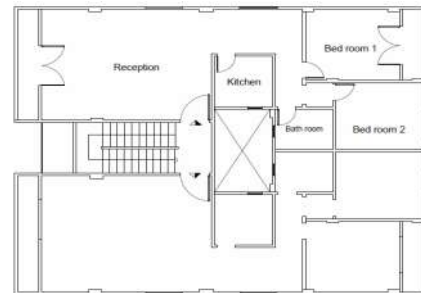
مسقط أفقى دور متكرر قبل التعديل
